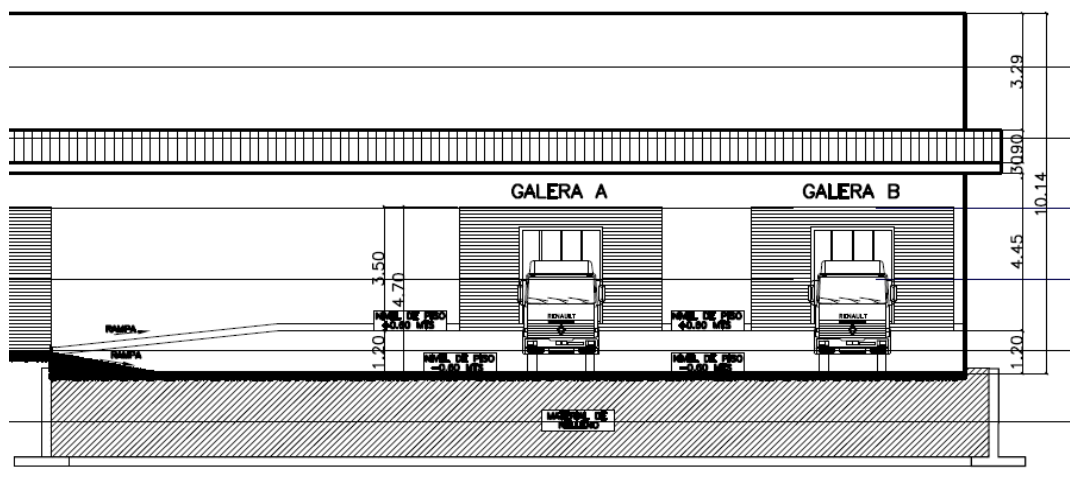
Vista frontal de las Galeras a construir. Fuente: Planos del Proyecto.
